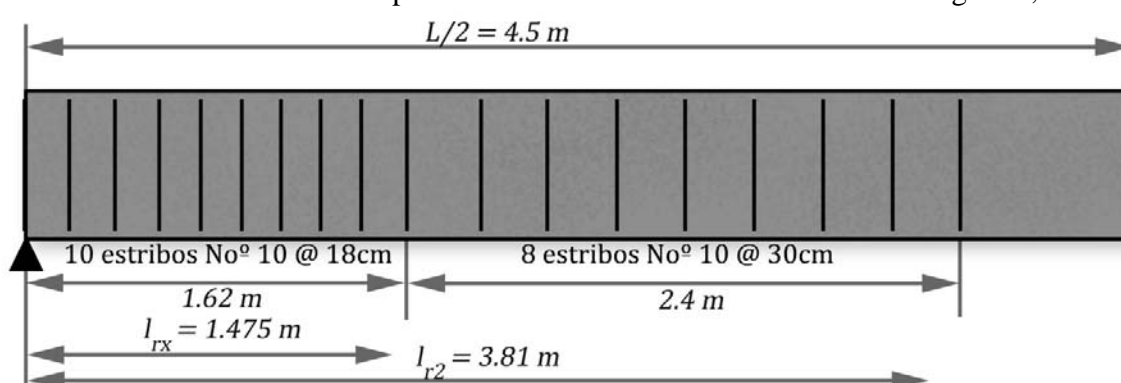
,43: Distribución del refuerzo transversal en los apoyos centrales, parte derecha
